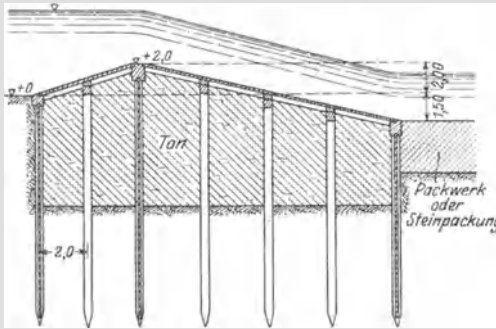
Festes Wehr mit gestampftem Ton, mit Holz abgedeckt. Maßstab 1:450.
